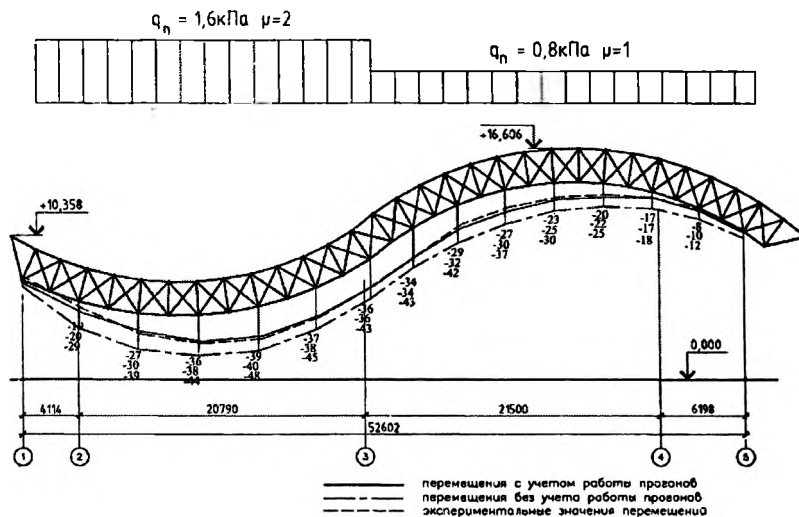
Схема загрузки покрытия снеговой нагрузкой и эпюры вертикальных перемещений узлов нижней поясной сетки по оси «В»
